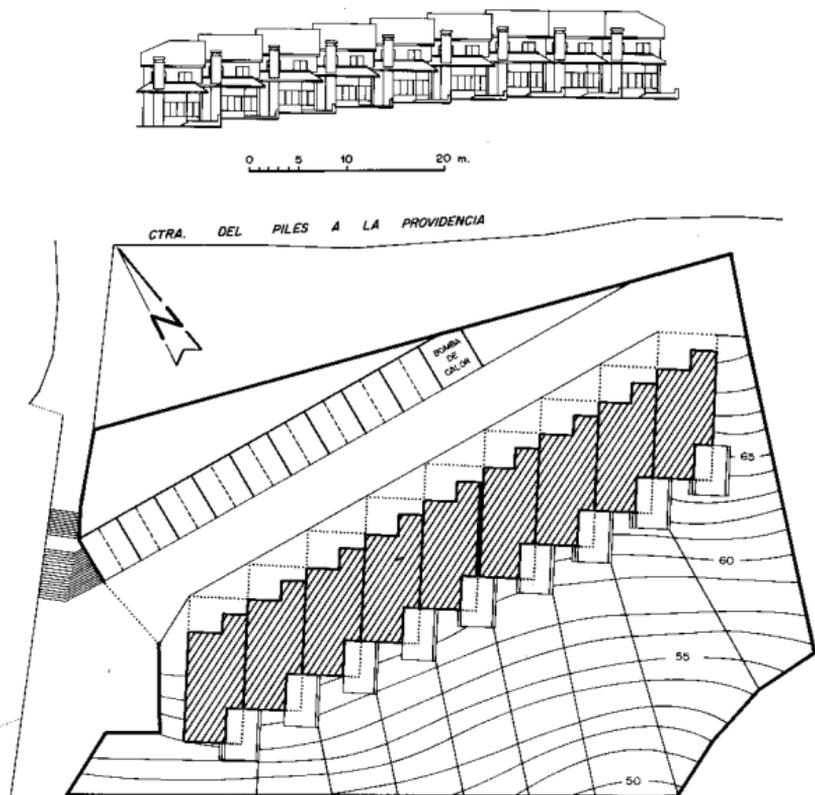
Planta y alzado de una urbanización en ladera: "La Campa", en la carretera del Piles a La Providencia. 1985.
